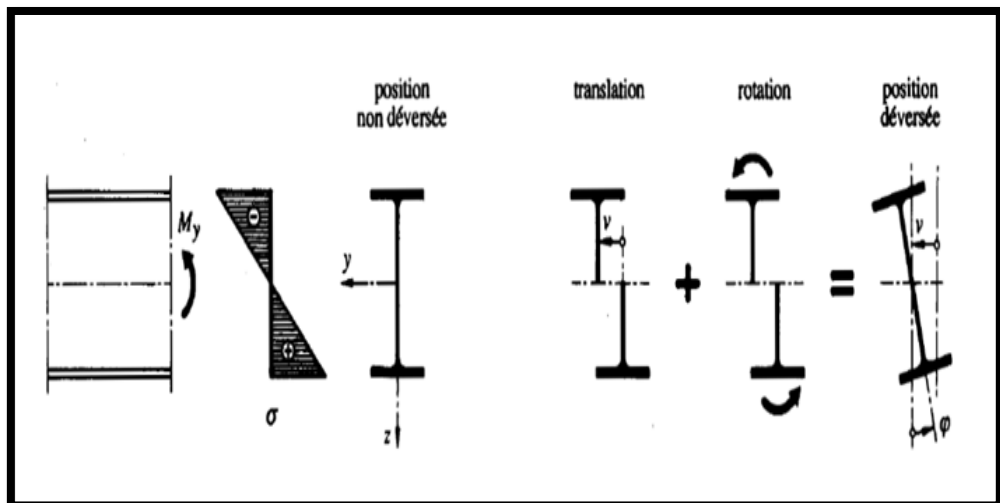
Translation et rotation d'un élément de poutre sujet au déversement.
